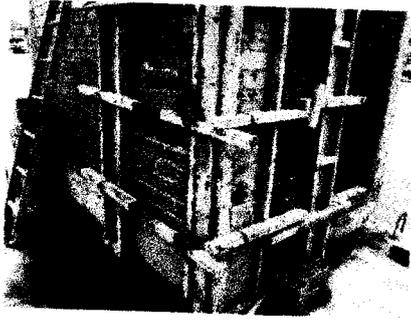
y 33: Encofrado, acero y concreto en columnas, vigas y sobrecimientos para caseta de bombeo, partida considerada en estructuras sanitarias. PUENTE DE ACCESO AL MUELLE
